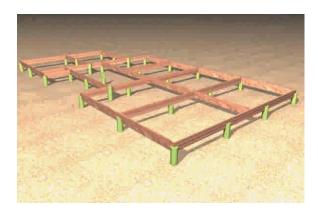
15: Vigas friso (viga perimetral) y vigas principales (vigas interiores) que unen las cabezas de los pilotes y transfieren las diferentes cargas de la estructura de la vivienda a la fundación aislada.
